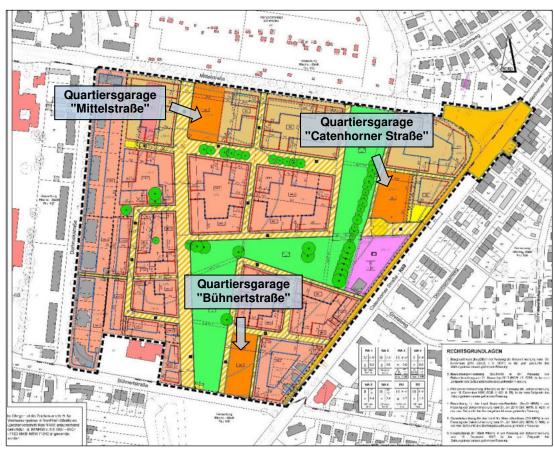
Planzeichnung zum Bebauungsplan /11/
